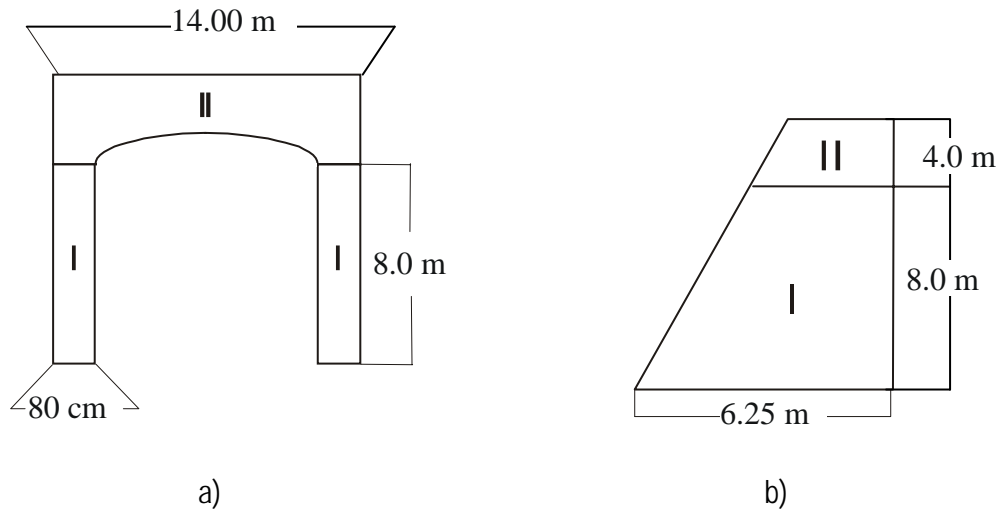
Vistas a) Frontal y b) Lateral de los portales de los túneles que se construirán para esta autopista.
